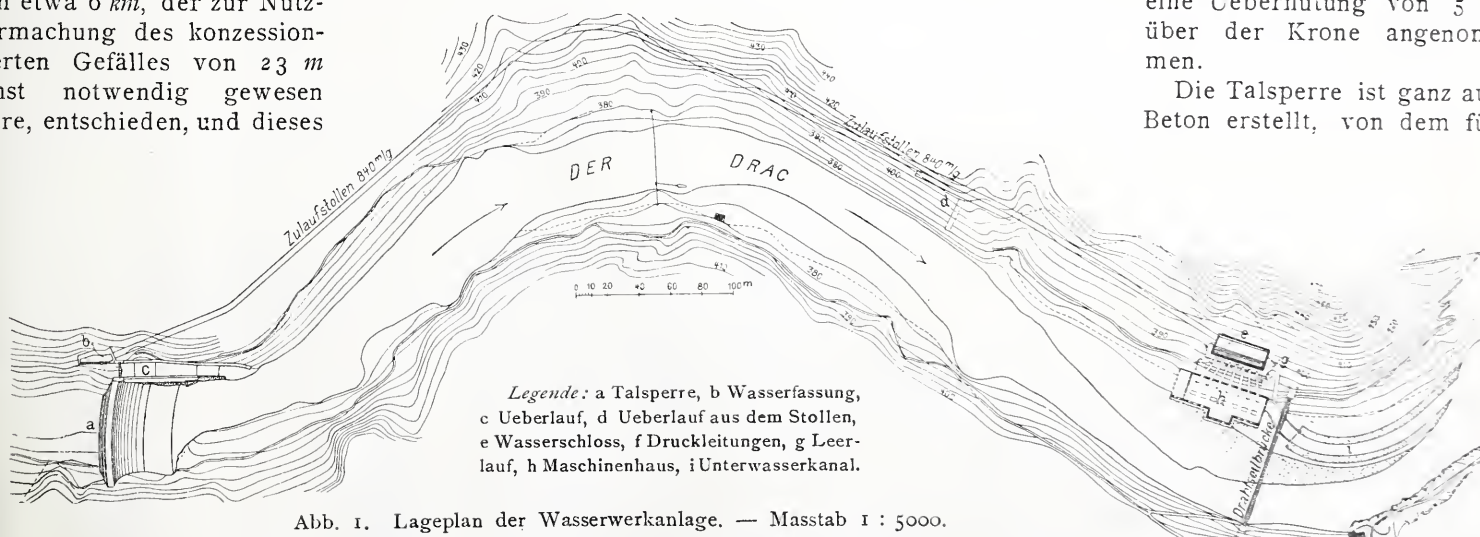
Lageplan der Wasserwerkanlage. — Masstab 1 : 5000.
